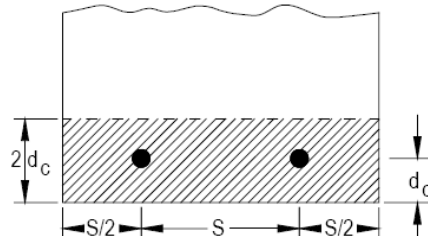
Parámetros geométricos para el cálculo del ancho de las fisuras (ACI 224-2R-92)
